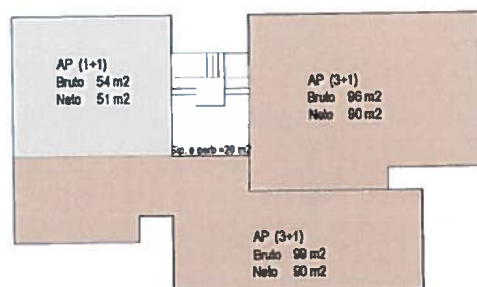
Planimetria katit te pestë dhe gjashtë
